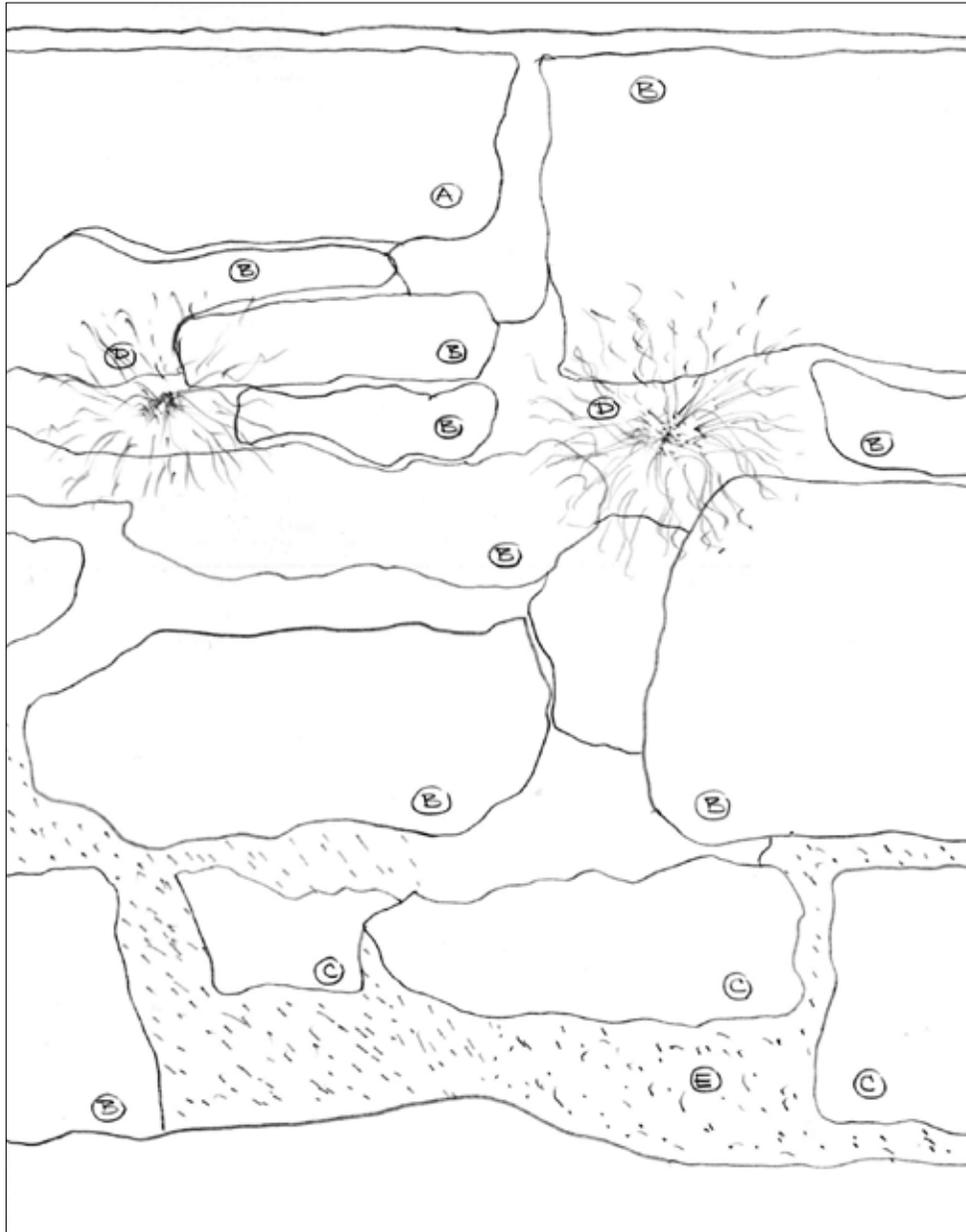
Gewölbeaufbau mit wasserführender Schicht
